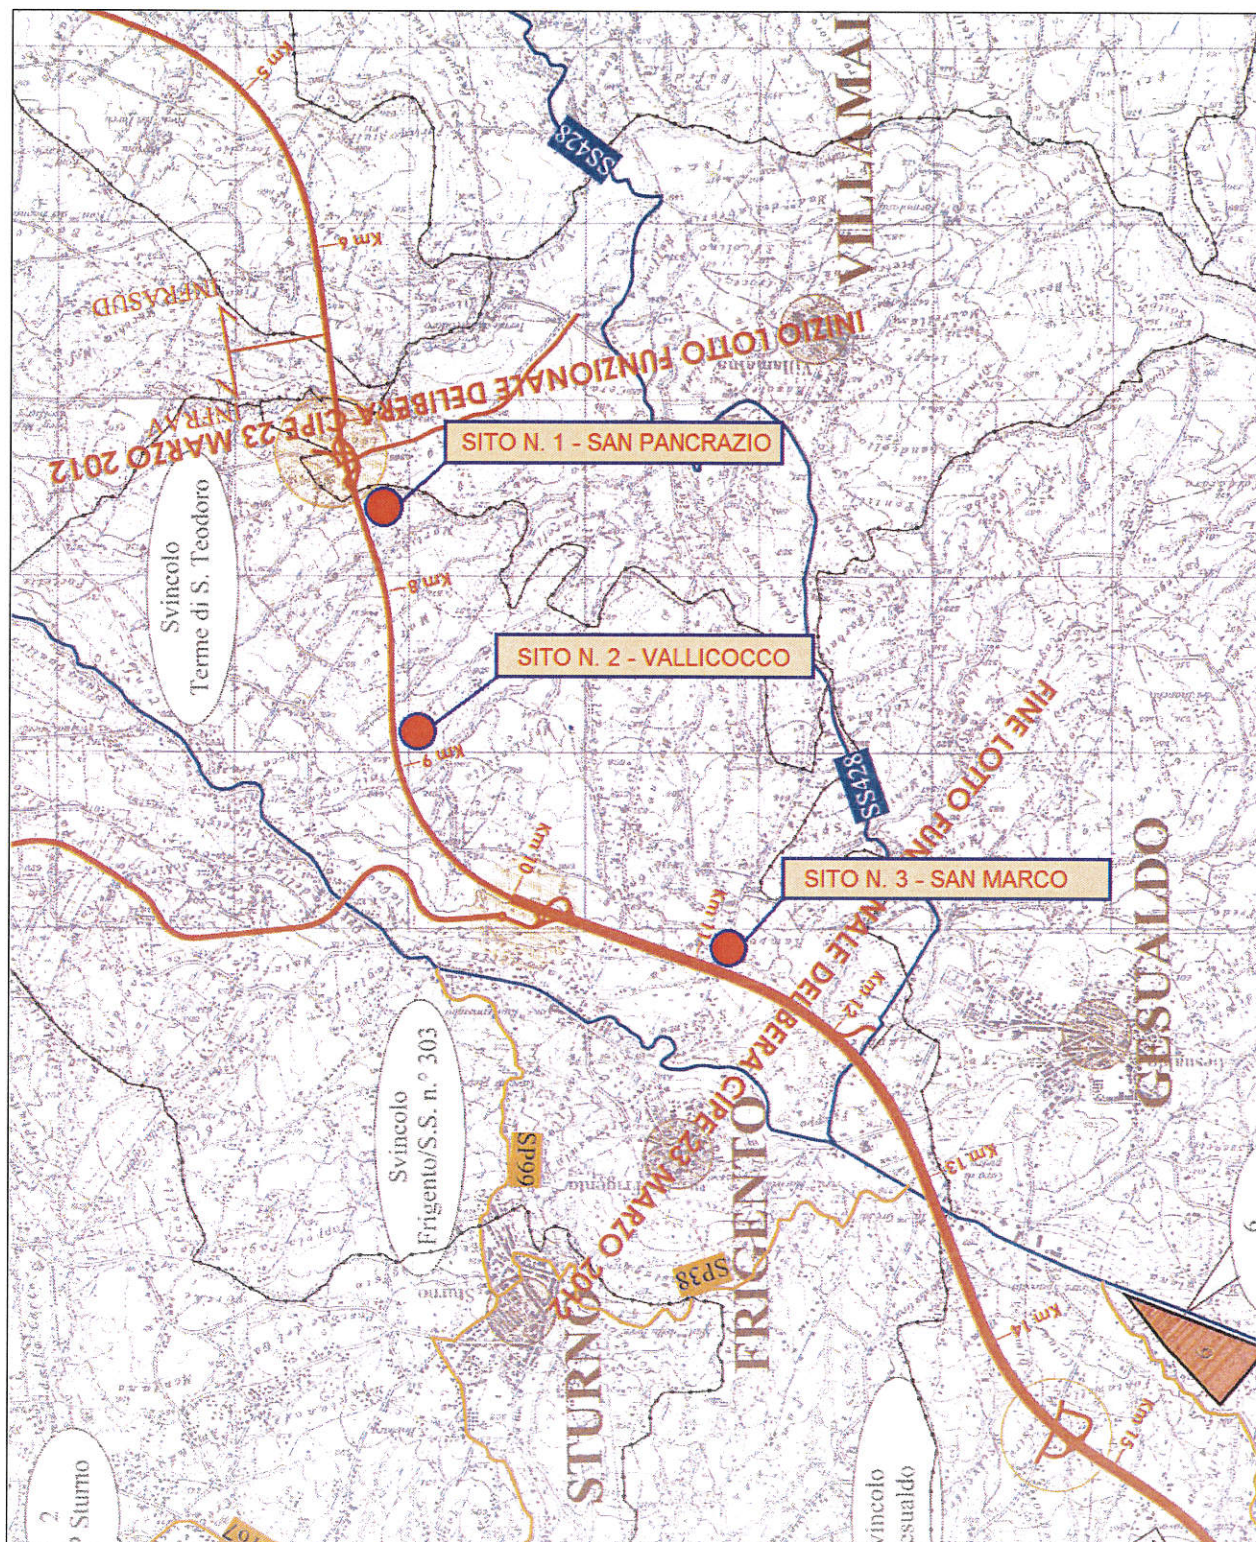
Localizzazione delle diverse aree di lavoro lungo il cantiere
